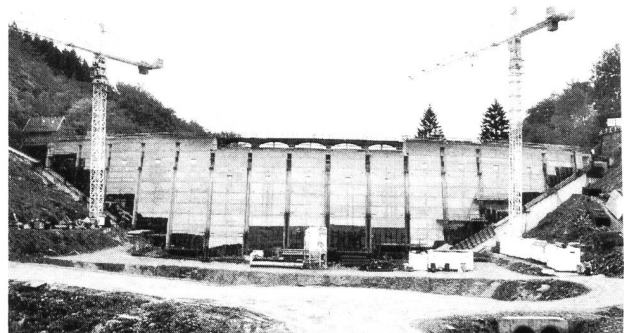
Sanierung der Bruchsteinmauer mit einer anliegenden Dichtwand aus Beton (Betonbild).
